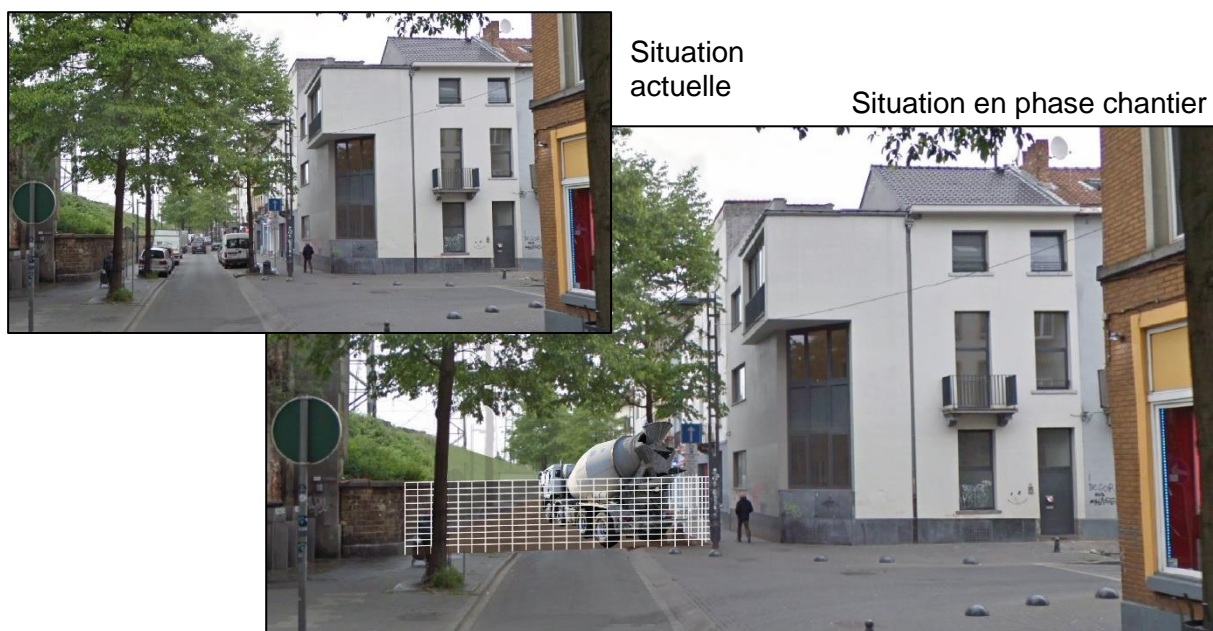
Emprise du chantier au niveau de la rue d'Aerschot lors de la construction du puits P5 et du tunnel
